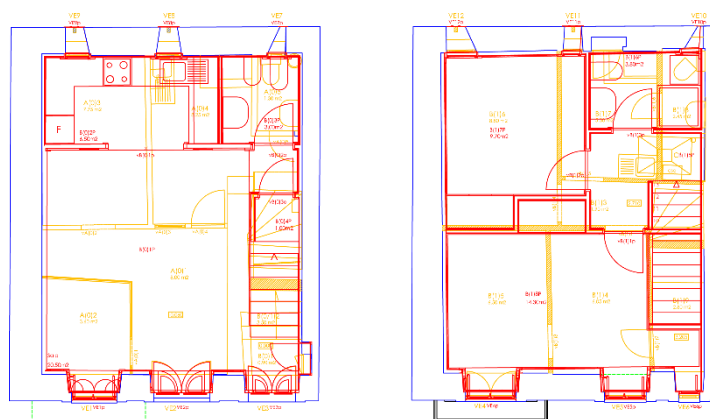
Planta Piso Térreo - Demolição/Construção Fig. 295 – Planta Piso Térreo - Demolição/Construção
